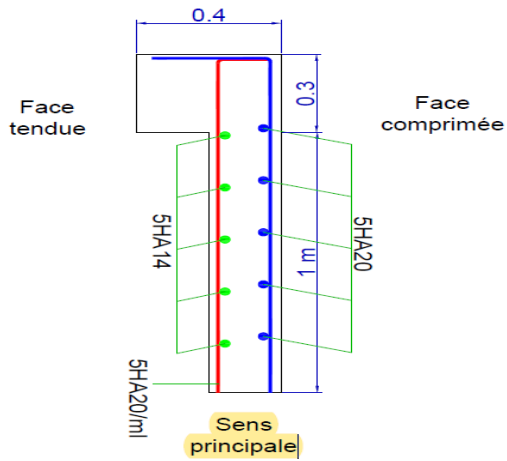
Schéma de ferrailage (Section transversale) du sens principale Du voile périphérique
